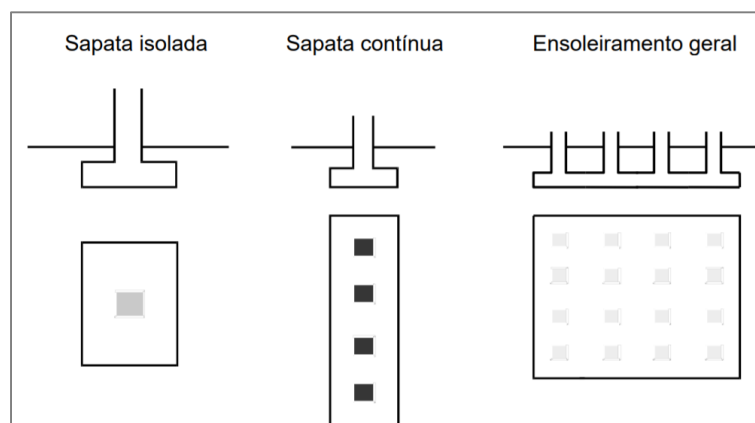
Tipos de fundações superficiais (<http://www.civil.ist.utl.pt>)
